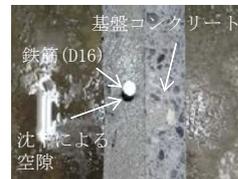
鉄筋周りのだれ 写真-2 切断後の試験体
